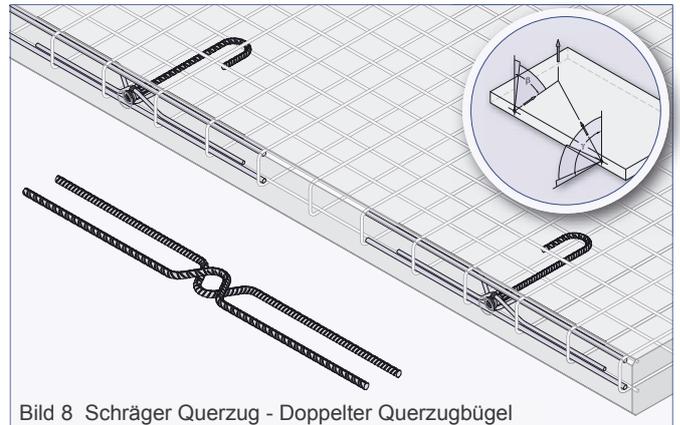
Schräger Querzug - Doppelter Querzugbügel
